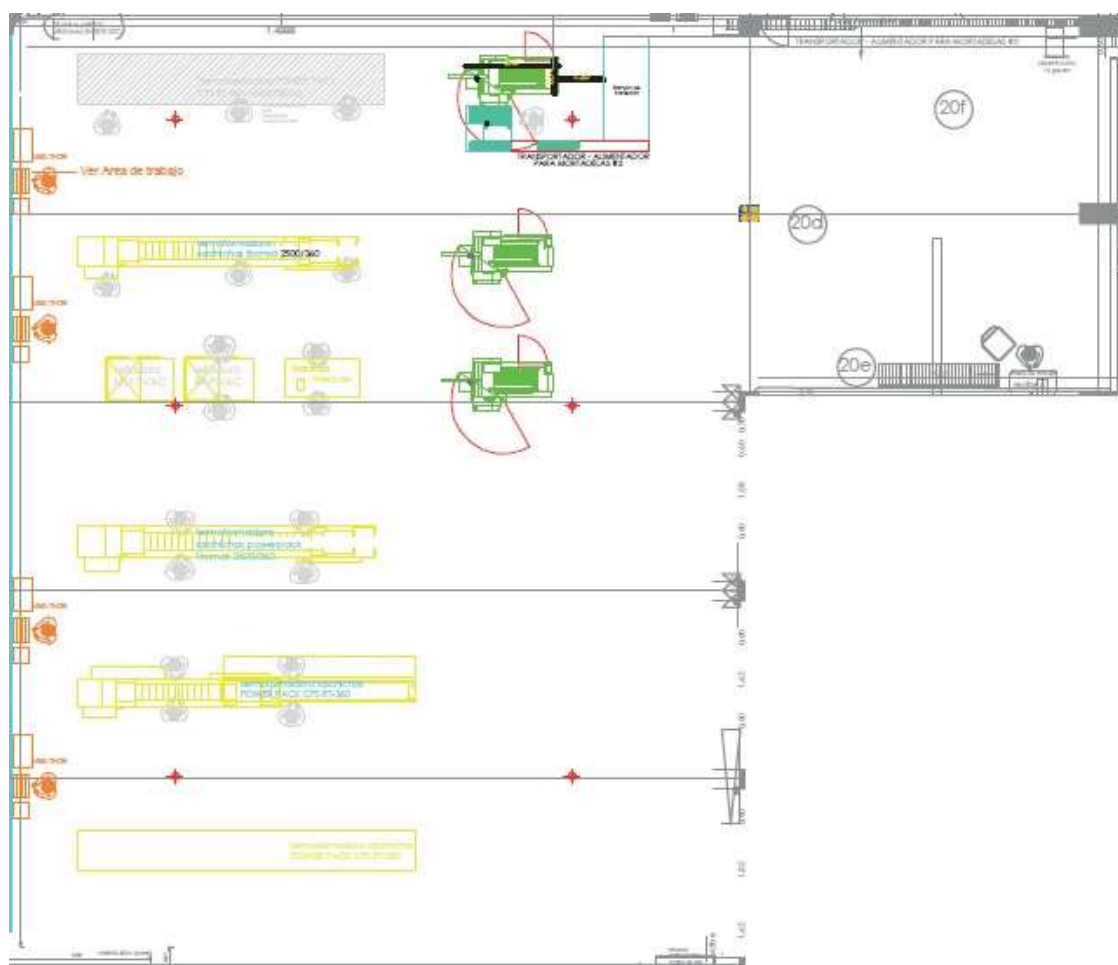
Plano del área de empaque de rebanados, horneados y salchichas
